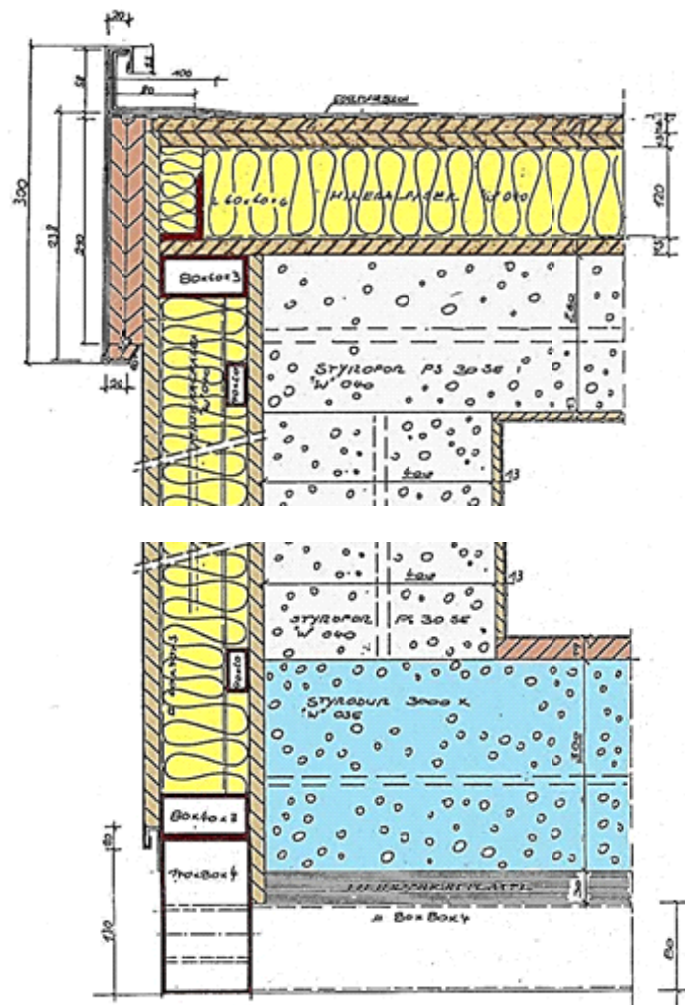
Sección de las paredes de la sala de ensayo con el esquema constructivo de materiales
